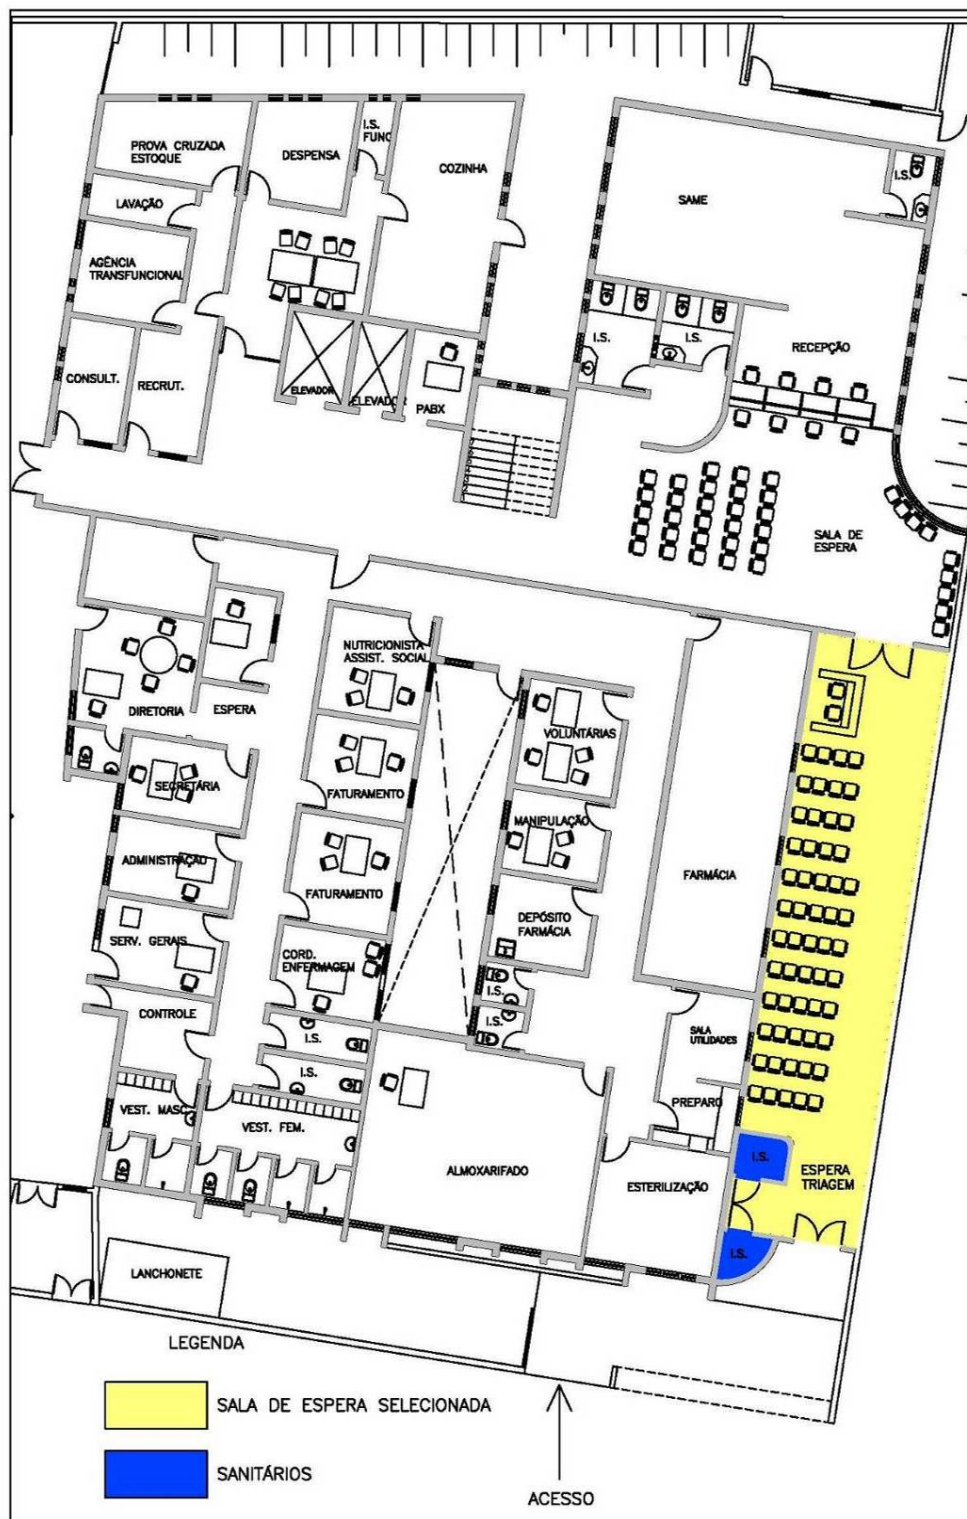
Planta arquitetônica do pavimento térreo do prédio principal do Hospital Mário Penna
